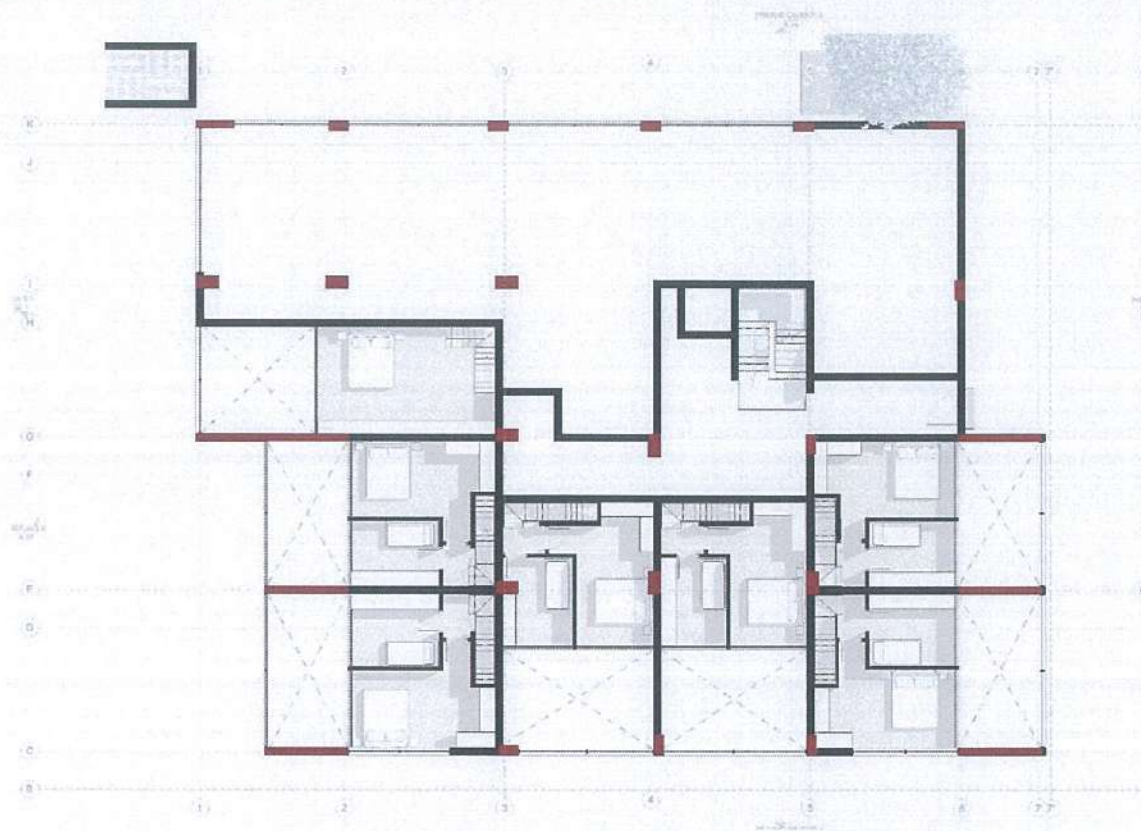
Planimetria e katit të ndërmjetëm Objekti A
